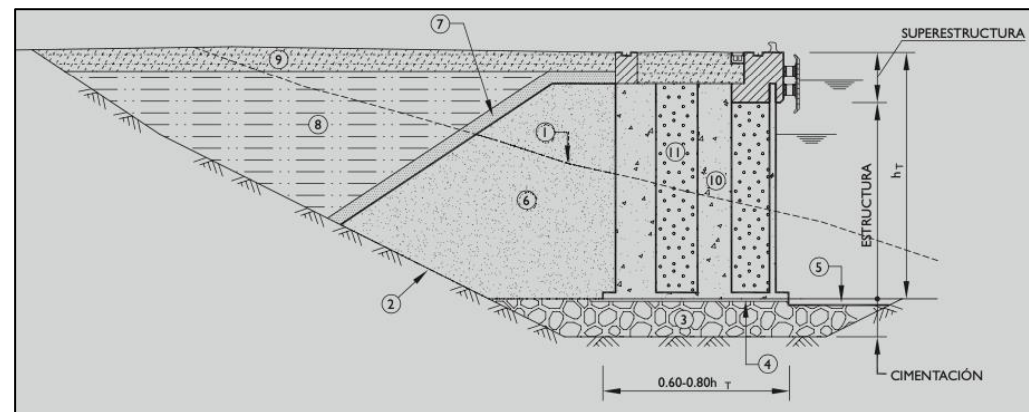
Sección tipo de un muelle de cajones de hormigón armado
